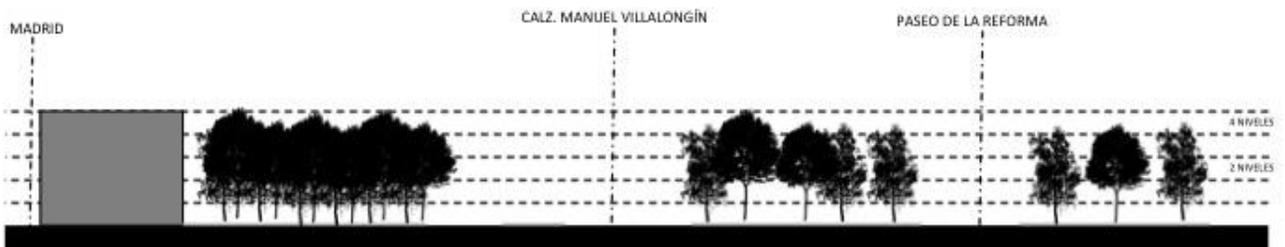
Perfil urbano que muestra las alturas sobre Insurgentes en dirección sur-norte después de la calle Sullivan.
